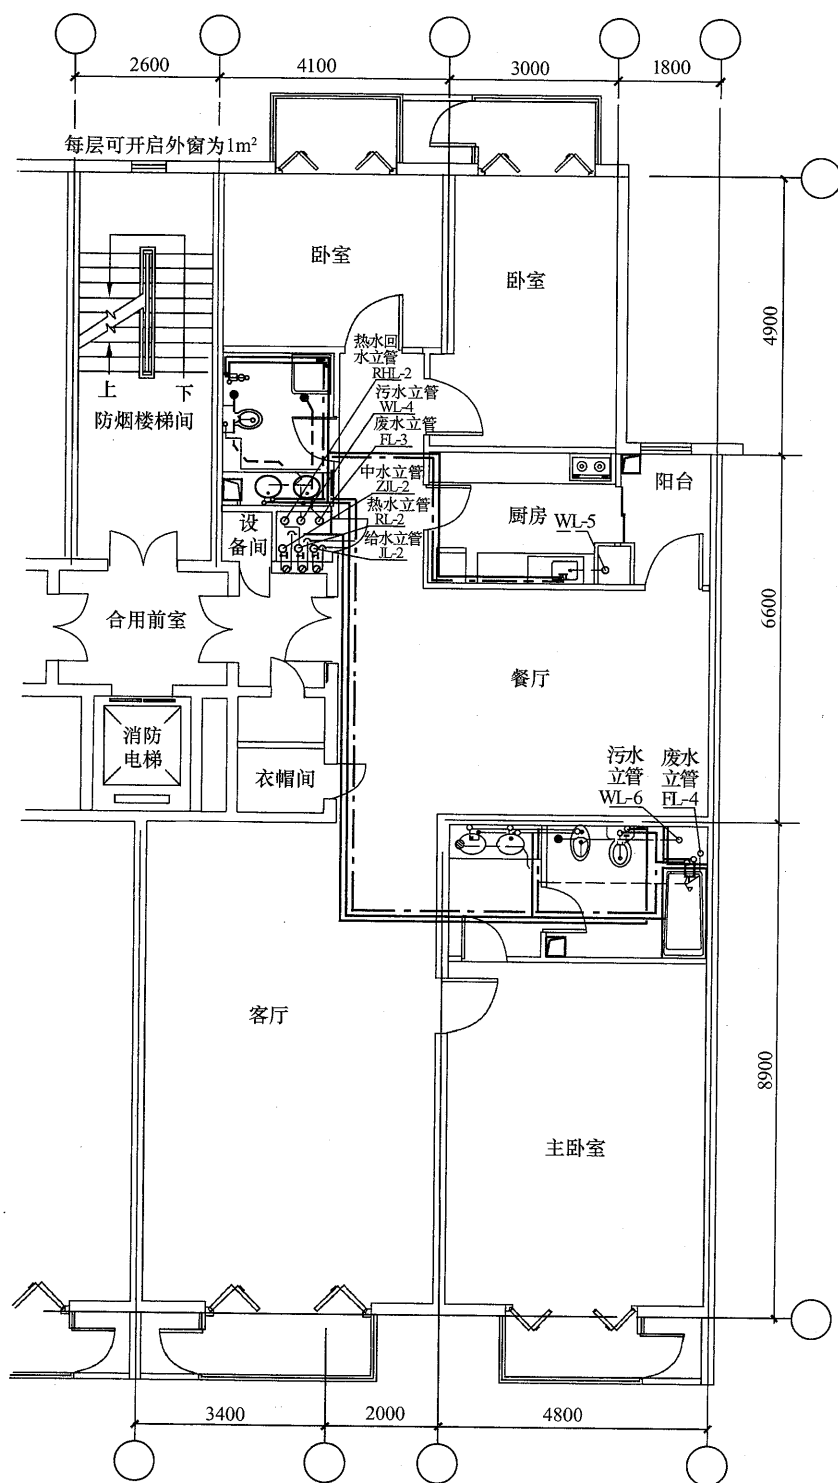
20 层居住建筑标准层某单元给排水平面图 (参考答案)
